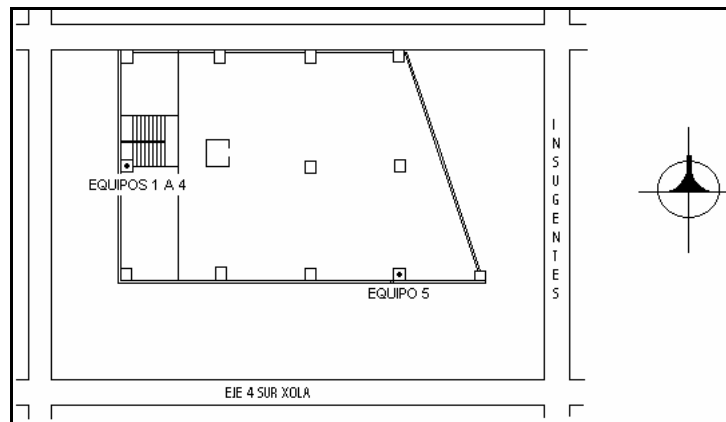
Planta tipo del edificio y ubicación de equipos de medición.
